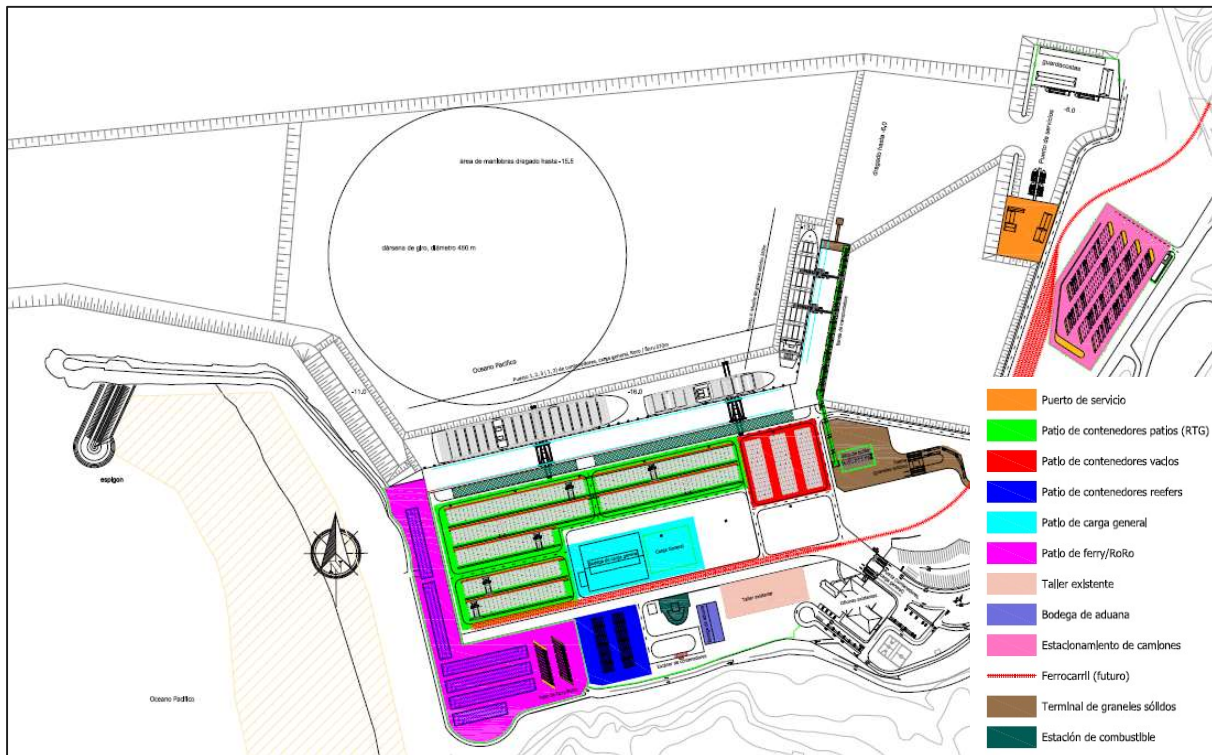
Plan Maestro de puerto Caldera Fase A
